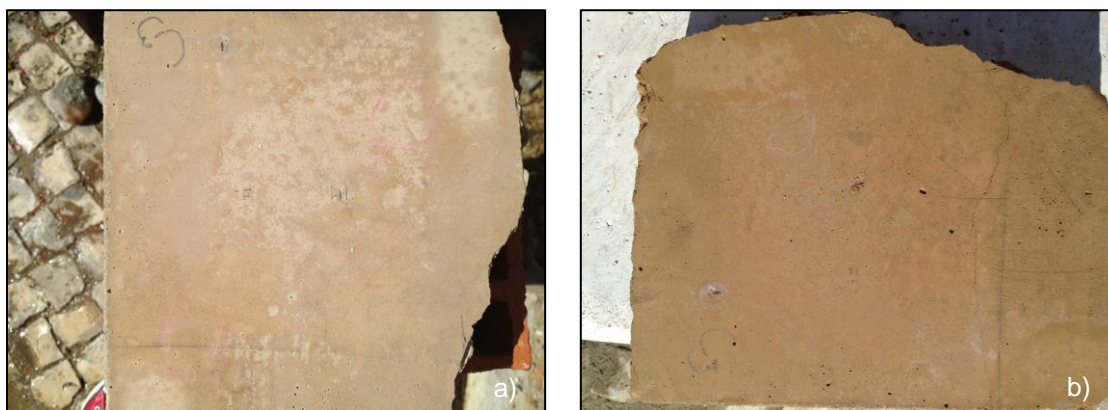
Face lisa de lajeta de betão C antes do ensaio (a); após o ensaio (b)
